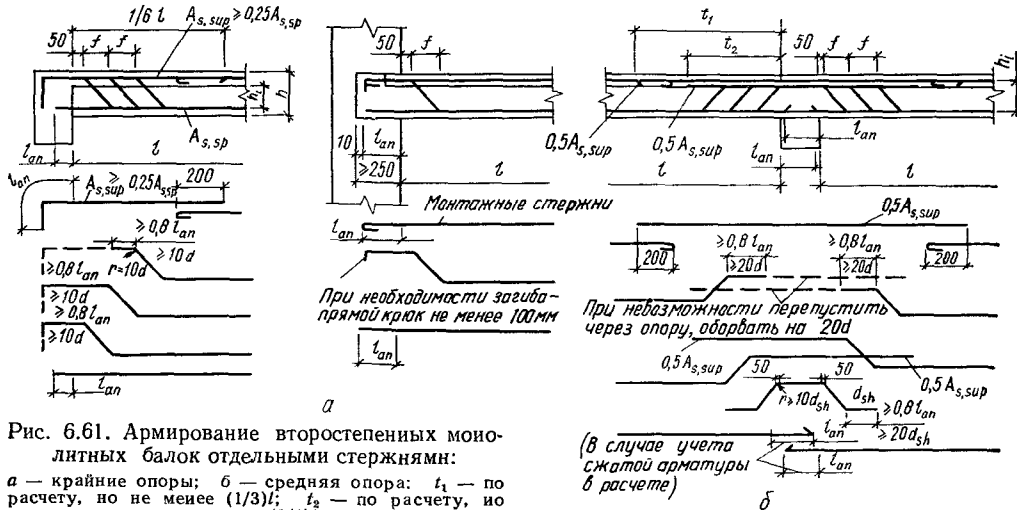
Армирование второстепенных монолитных балок отдельными стержнями:
